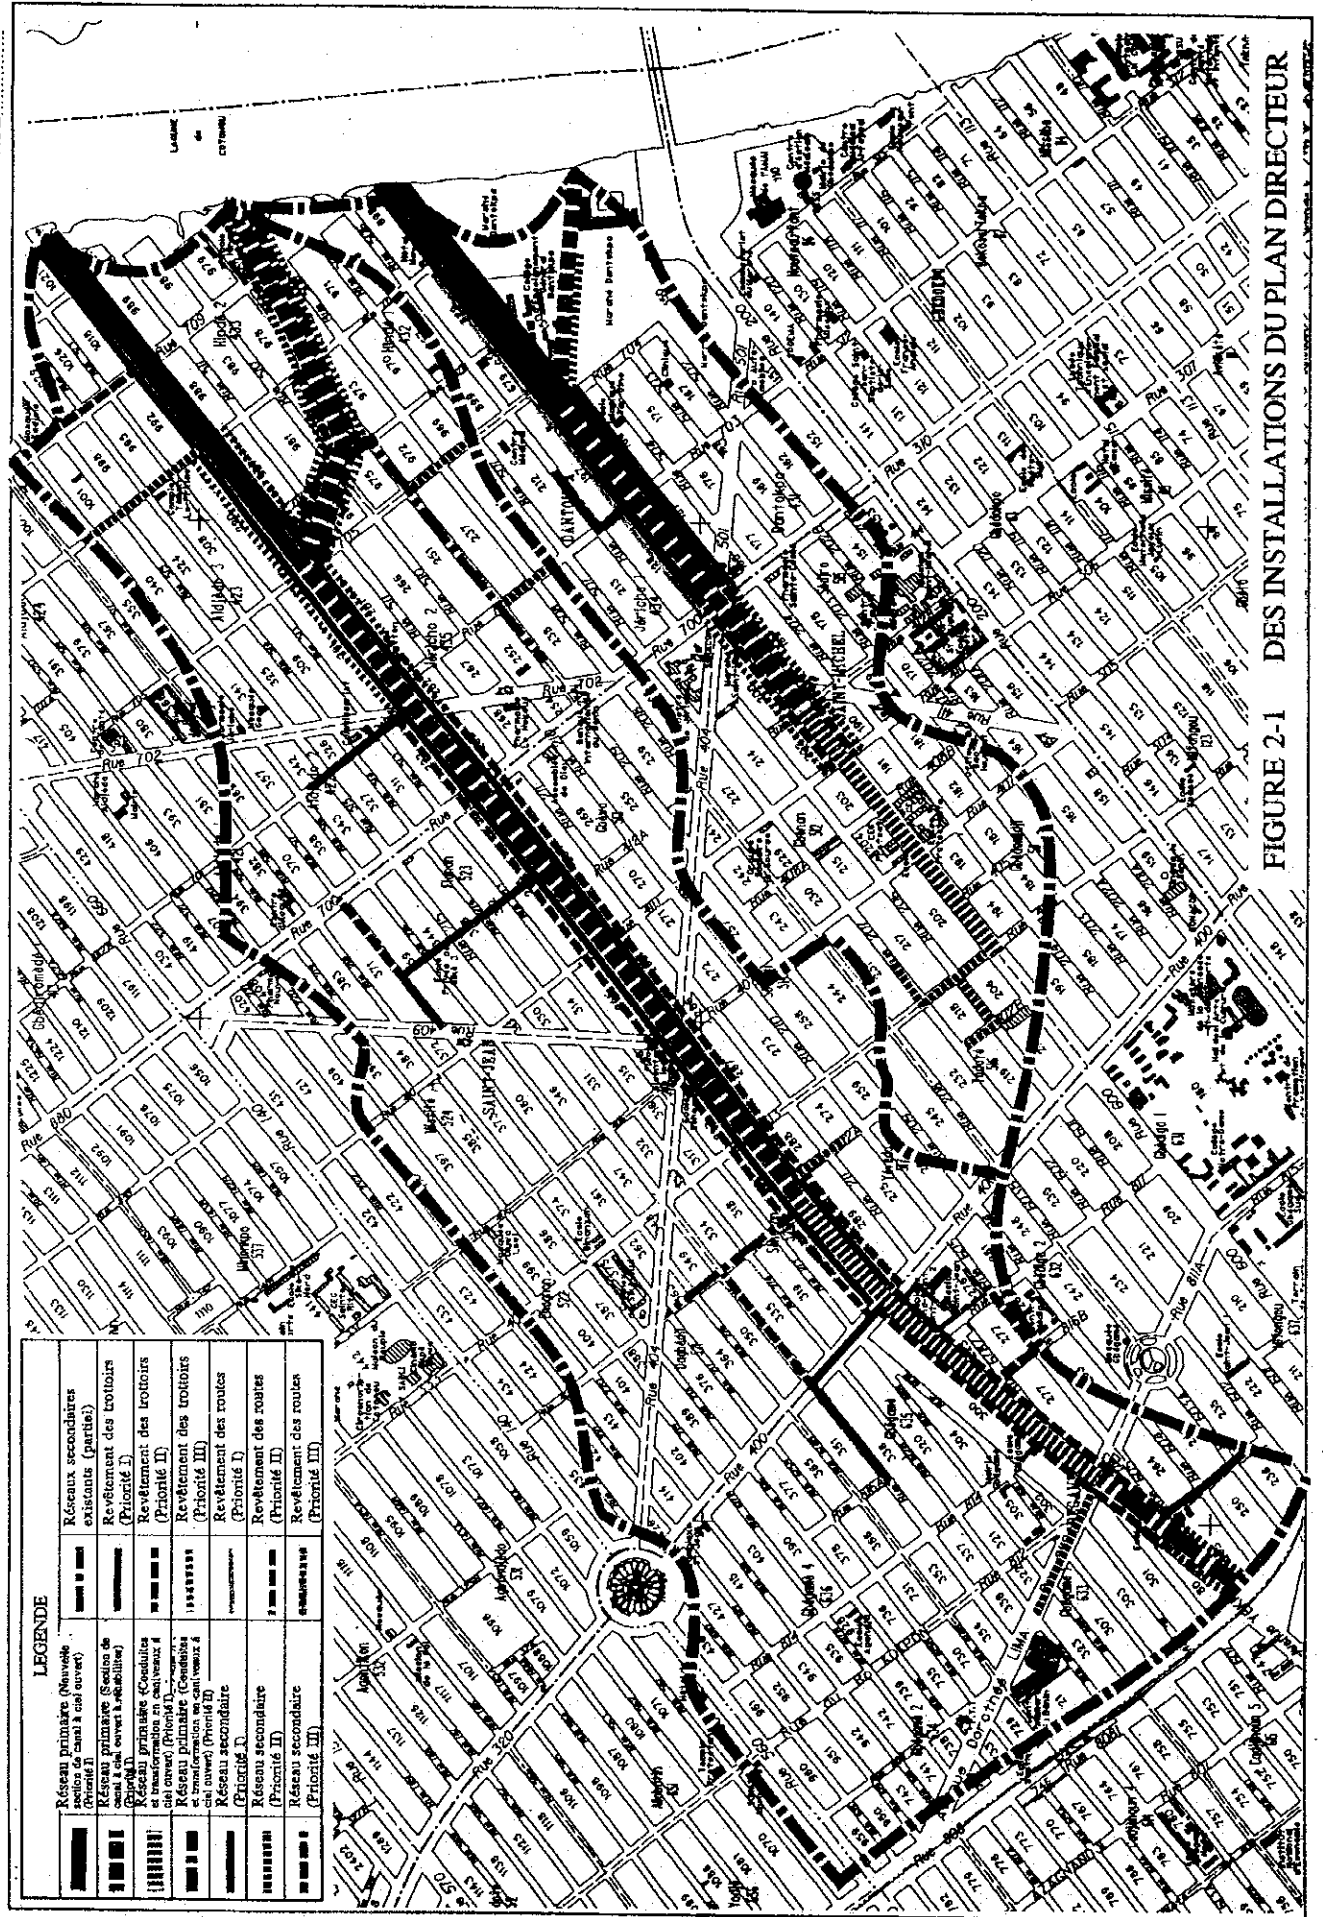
DES INSTALLATIONS DU PLAN DIRECTEUR
